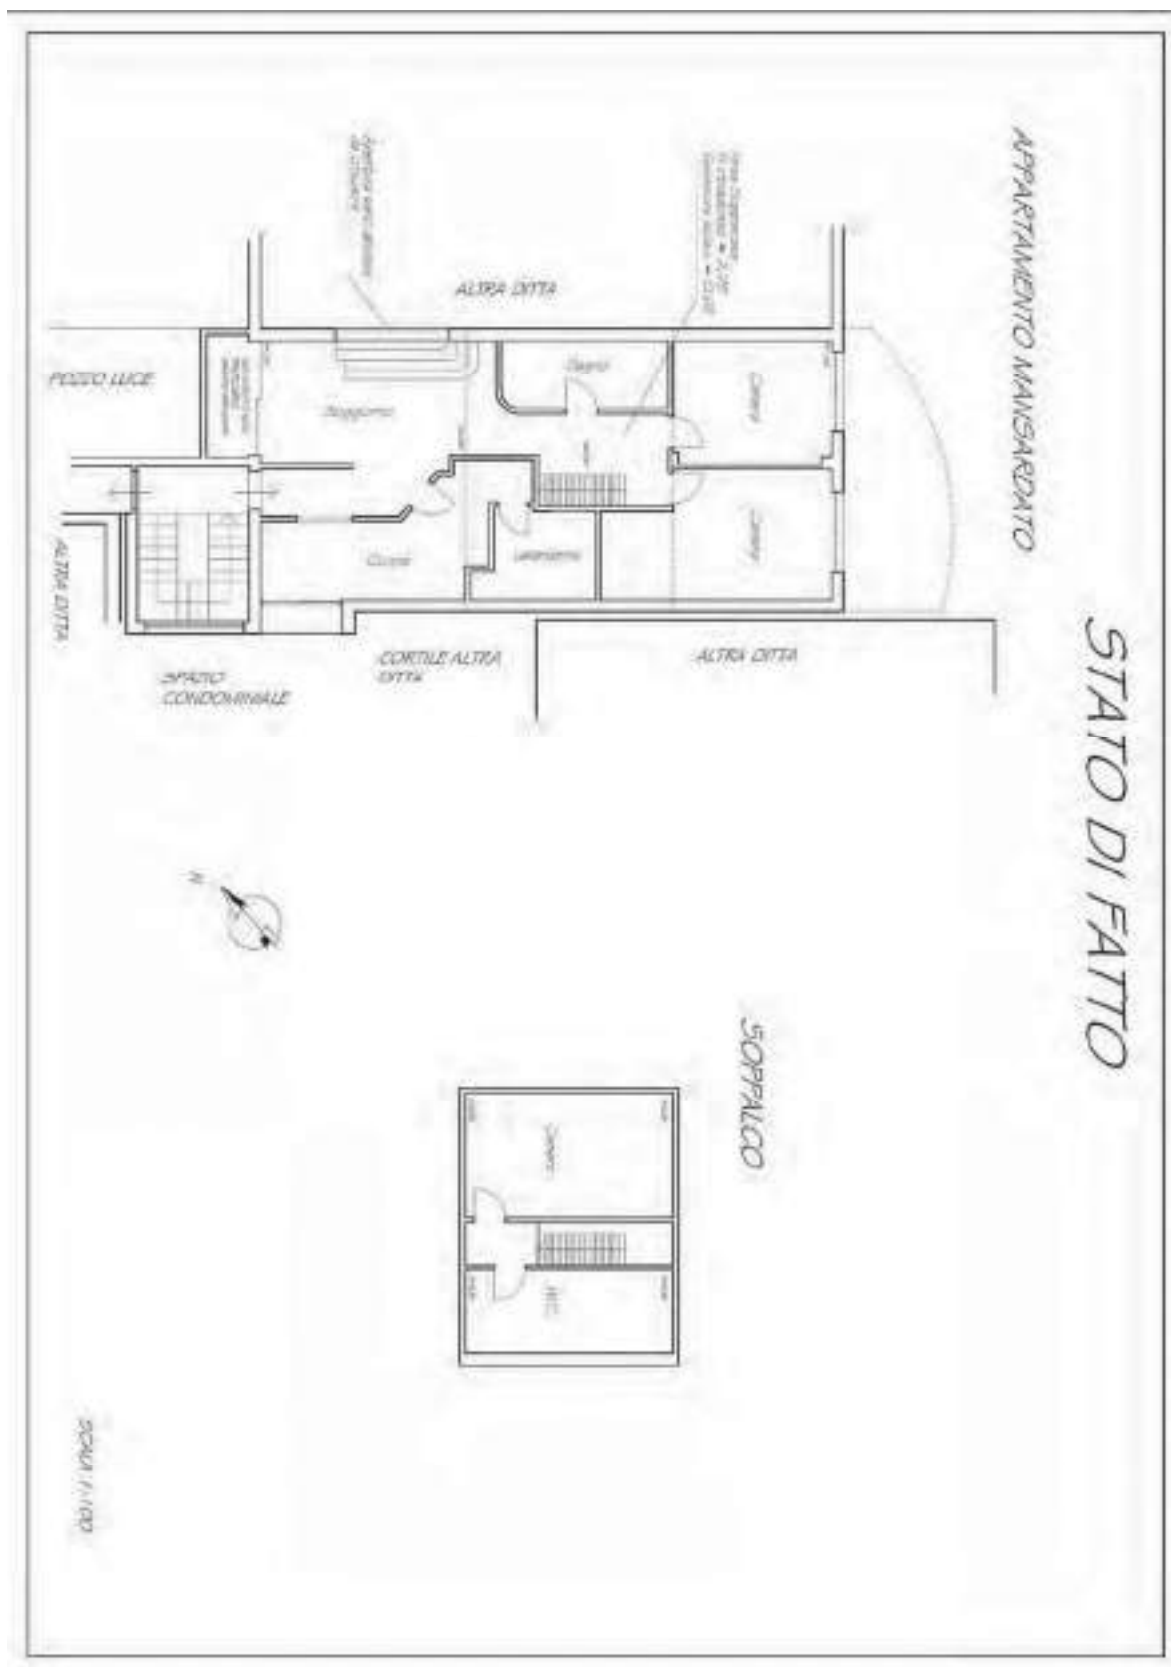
Planimetria Stato di Fatto (allegato fuori scala)
